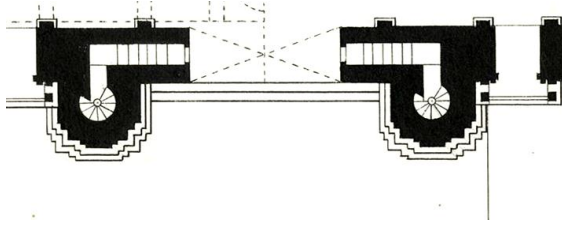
مسقط أفقي لقاعدة منذنة مالك عالم .
